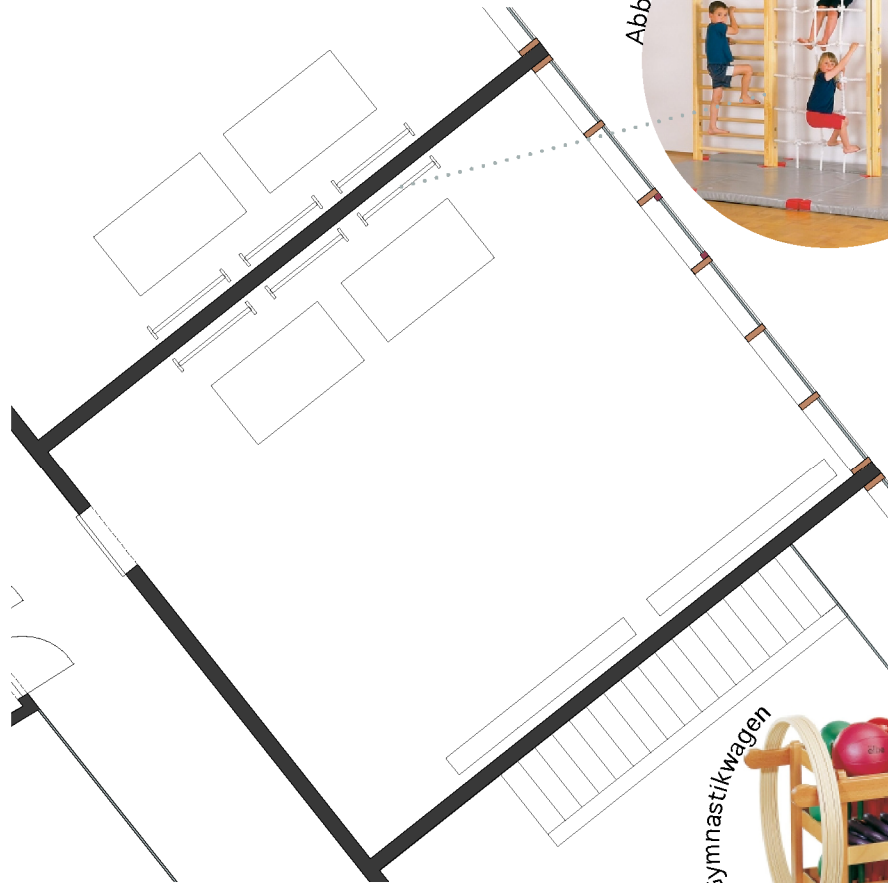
Grundriss Obergeschoss Bewegungsraum 1:100
